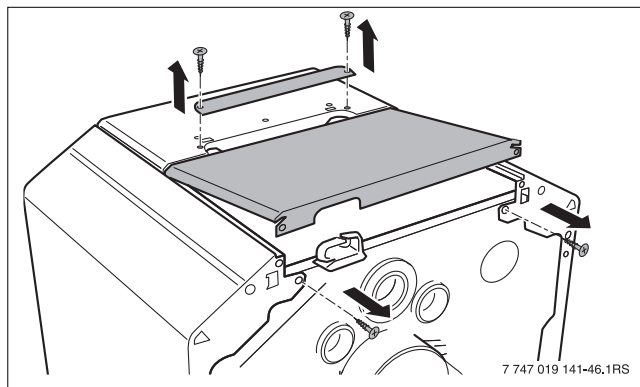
Retirer le capot arrière de la chaudière ainsi que la tôle de couverture
